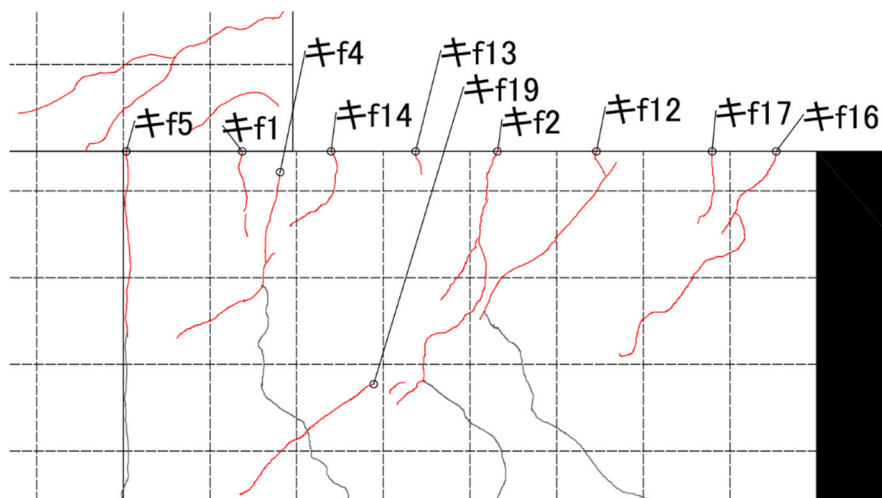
2. 3-107 南基礎梁ひび割れ幅測定位置 (試験体 DR-5 -7.0 サイクル 観測面)
